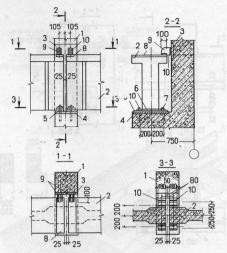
Крепление подкрановых балок к колоннам каркаса I — колонна; 2 — подкрановая балка; 3 — закладная стальная деталь колонны; 4 — опорный стальной лист консоли колонны; 5 — стальная прокладка с отверстиями для болтов; 6 — нижияя закладная стальная деталь подкрановой балки; 7 — анкерные болты; 8 — верхияя закладная стальная деталь подкрановой подкрановой балки; 9 — крепежный вертикально поставленный стальной лист; 10 — сварка
